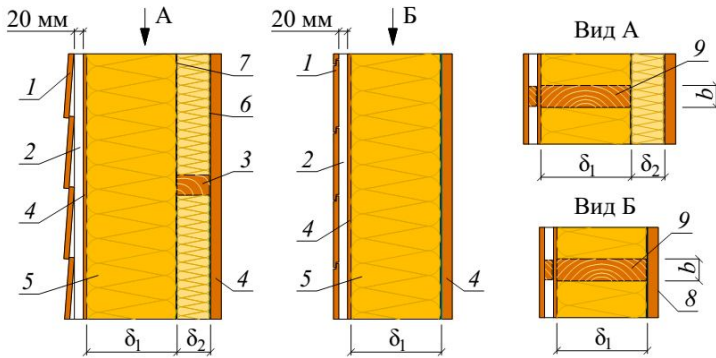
Конструкции наружных стен с деревянной рамой: 1 – наружная облицовка; 2 – 20 мм вентилируемого слоя; 3 – крестообразная вставка в тепловой изоляции; 4 – обшивка; 5 – тепловая изоляция; 6 – пароизоляция; 7 – альтернативное расположение пароизоляции; 8 – внутренняя облицовка; 9 – рейка (с шагом 0,6 м)
